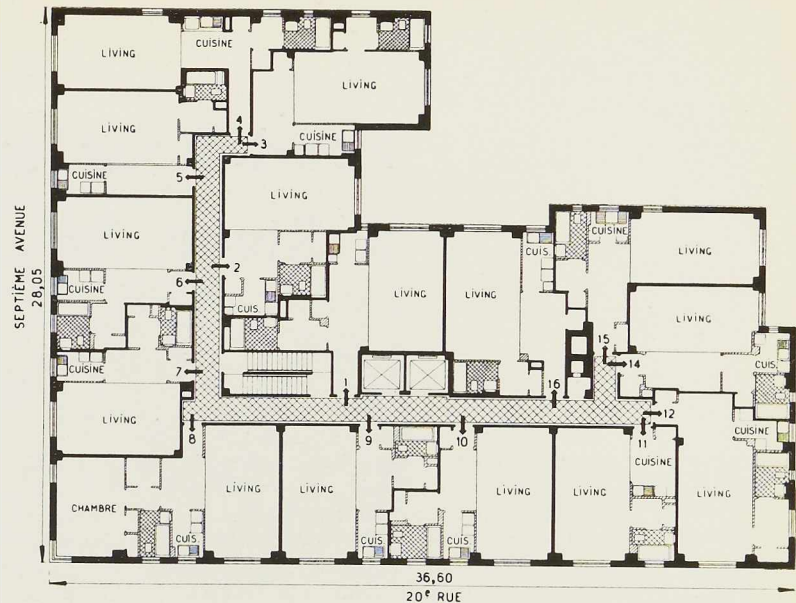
Plan d'un étage-type de l'immeuble montrant la disposition des appartements.
